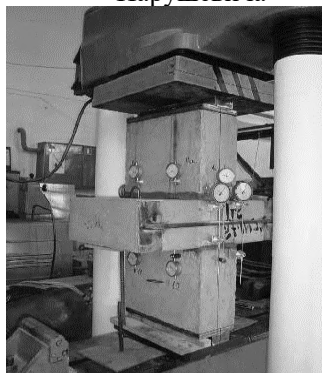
Общий вид опытного образца Байбурина, Мишнева, Румянцева
